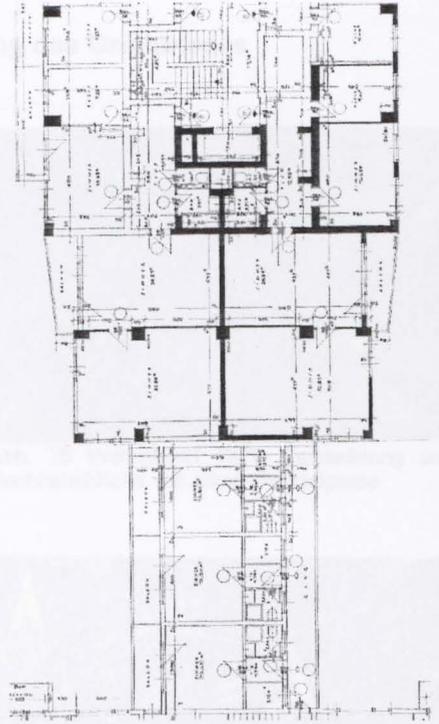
Elisabethhochhaus, Grundriss 1.OG
